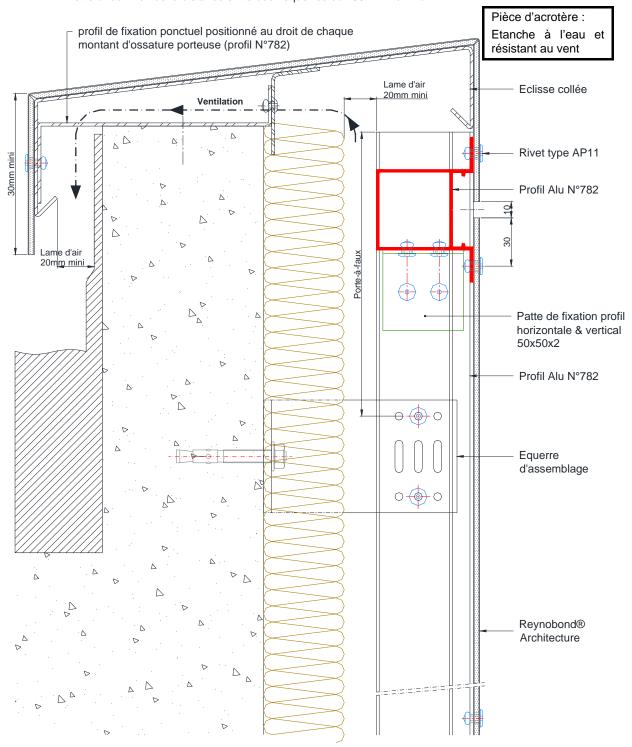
Arrêt sur acrotère – Coupe verticale - Système riveté RV 60 4c
